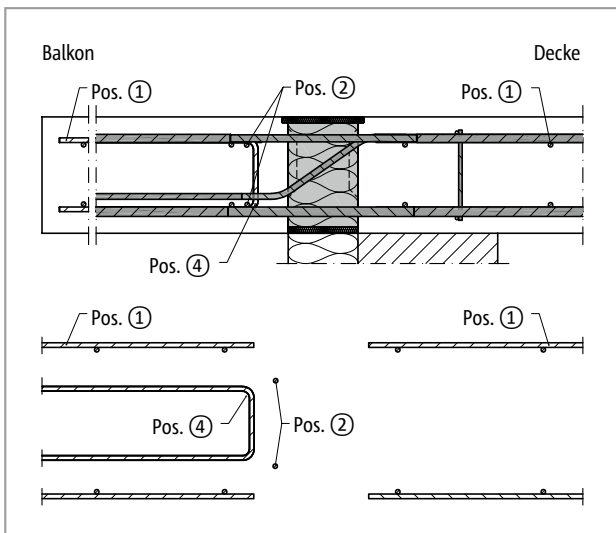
Schöck Isokorb® XT Typ K-M12 bis M13: Bauseitige Bewehrung bei direkter Lagerung
